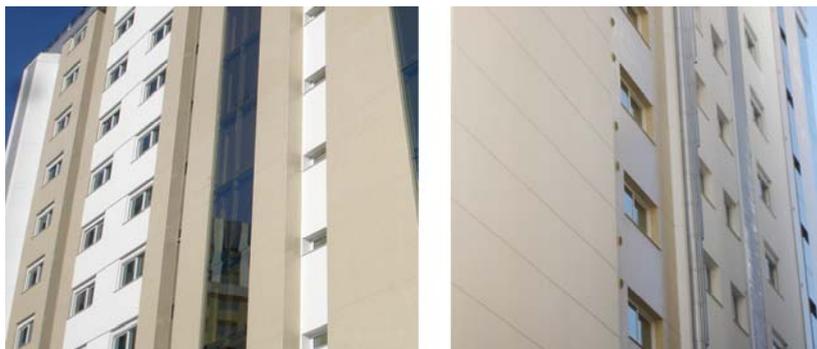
a- revestimento argamassado fachada Leste e b- frisos horizontais na fachada Oeste.
